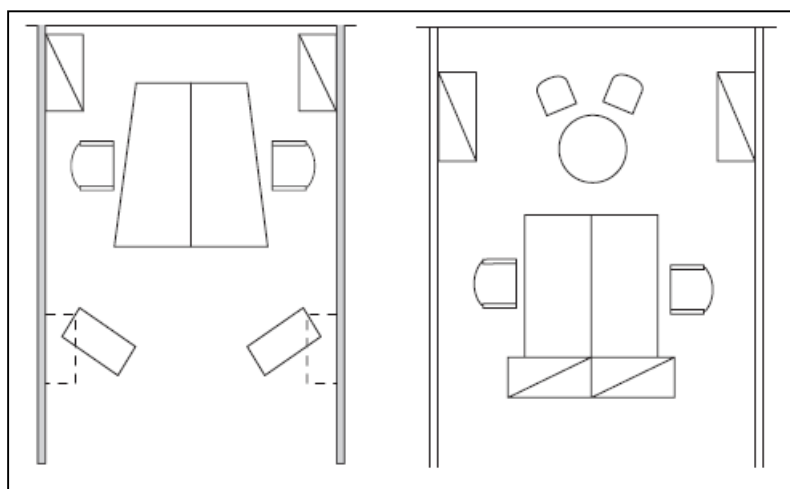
Beispiele für Grundrisse von Zweipersonenbüros mit Orientierung zueinander²²
